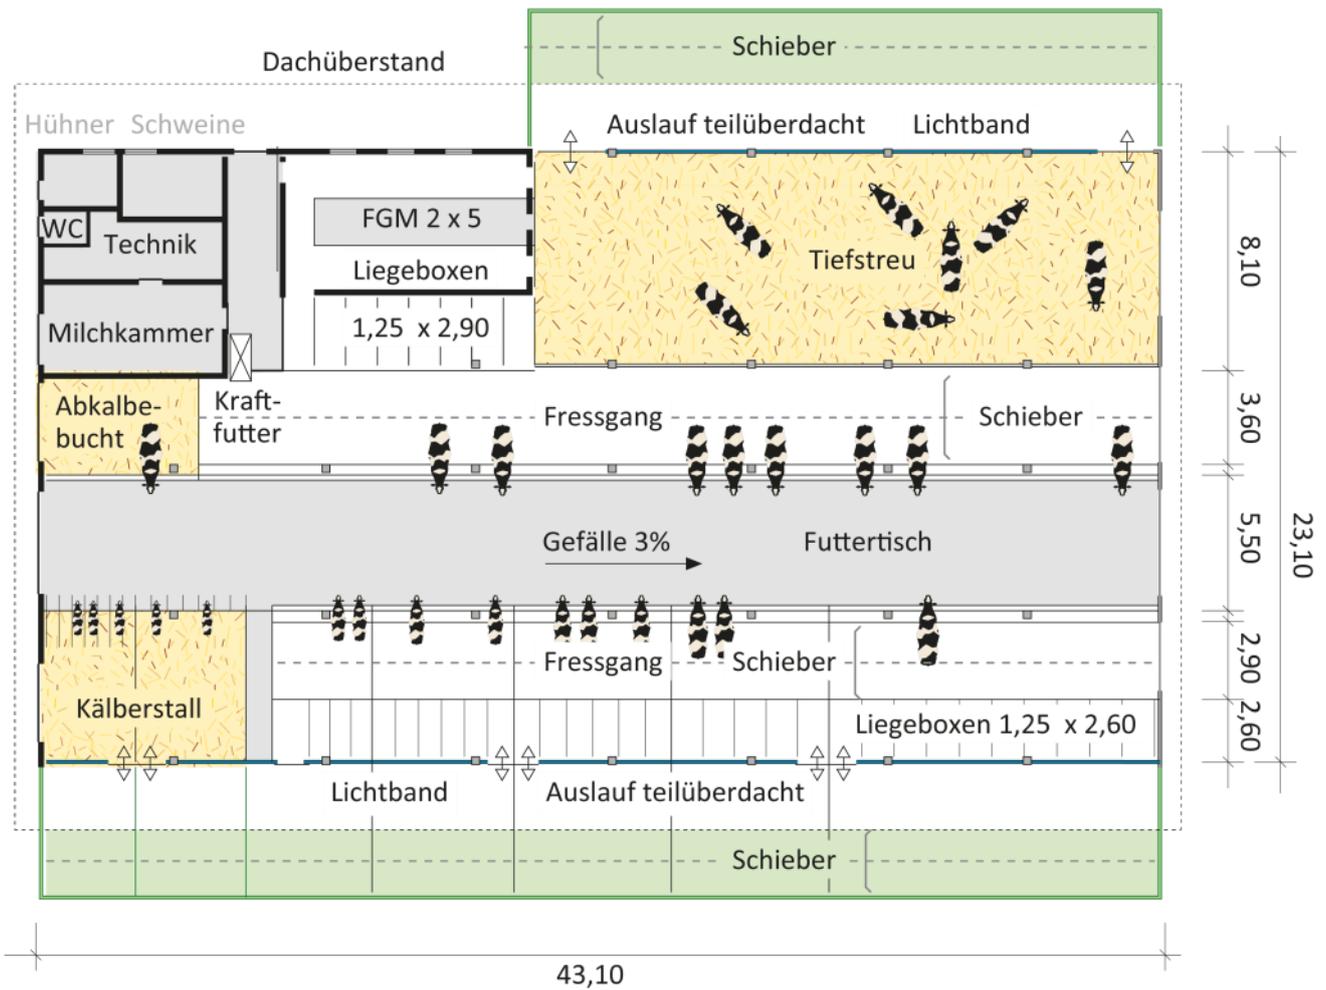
Grundriss - Betrieb F. und G. Enzenhofer
